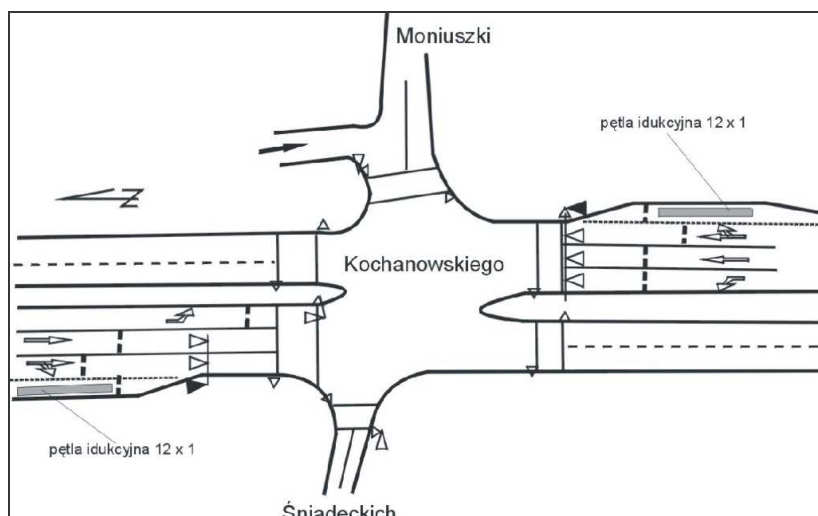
Lokalizacja wspólnych przystanków na rozbudowanym skrzyżowaniu wielowłotowym
